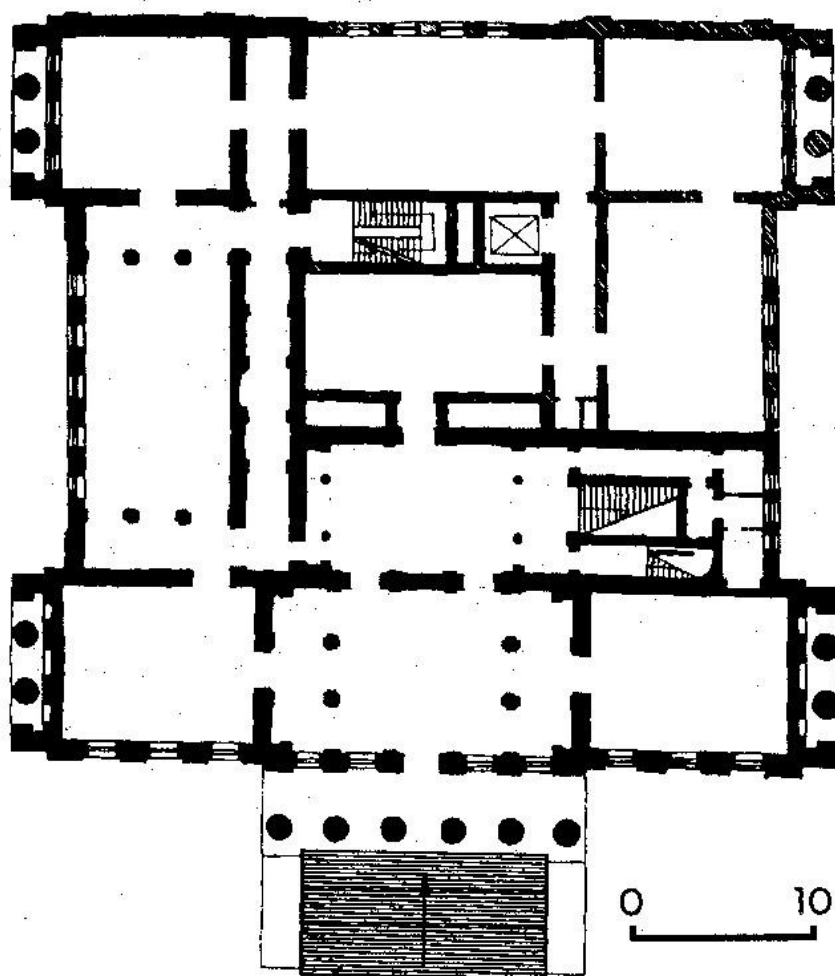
Креслення плану поверху будівлі [66]
